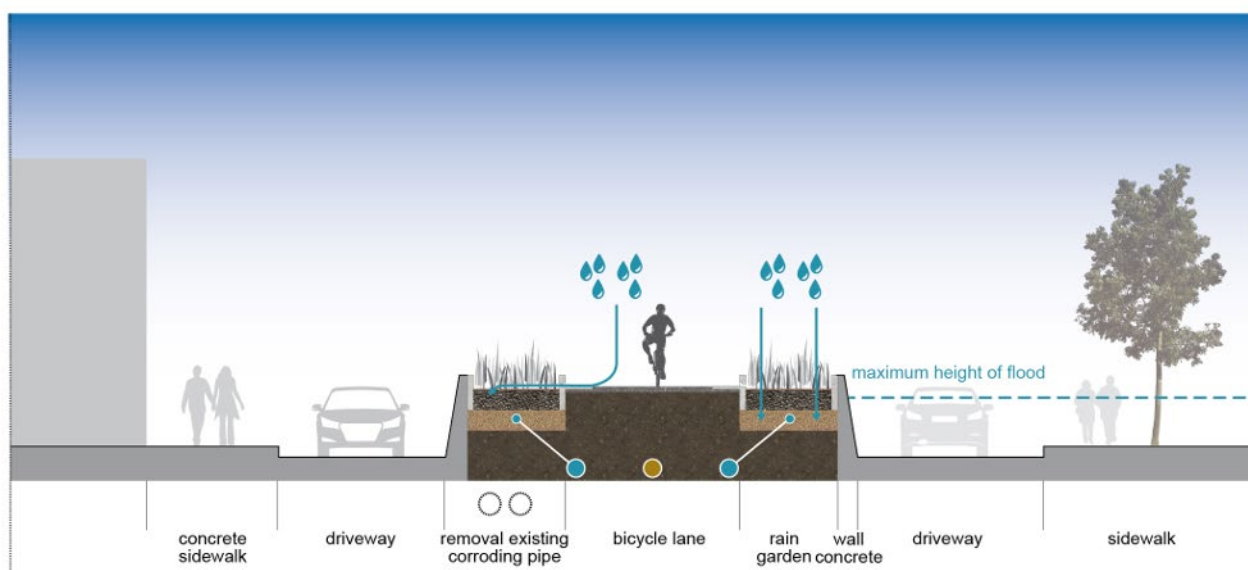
San Rafael, sezione di Canal Street. Fonte: disegno originale dell'arch. M. Padrone.
